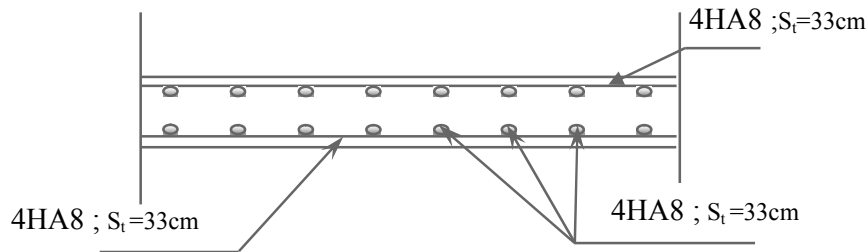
Schéma de ferrailage de la dalle (D1) et (D3) et(D4).
